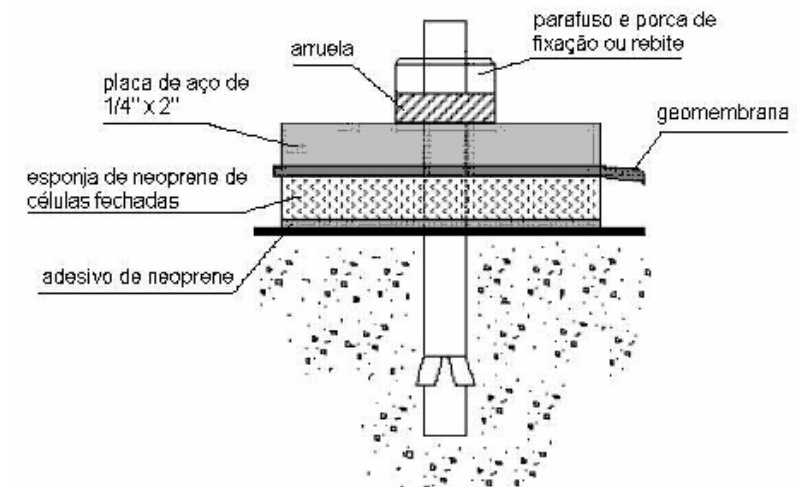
Exemplo de fixação da geomembrana à base de concreto.
